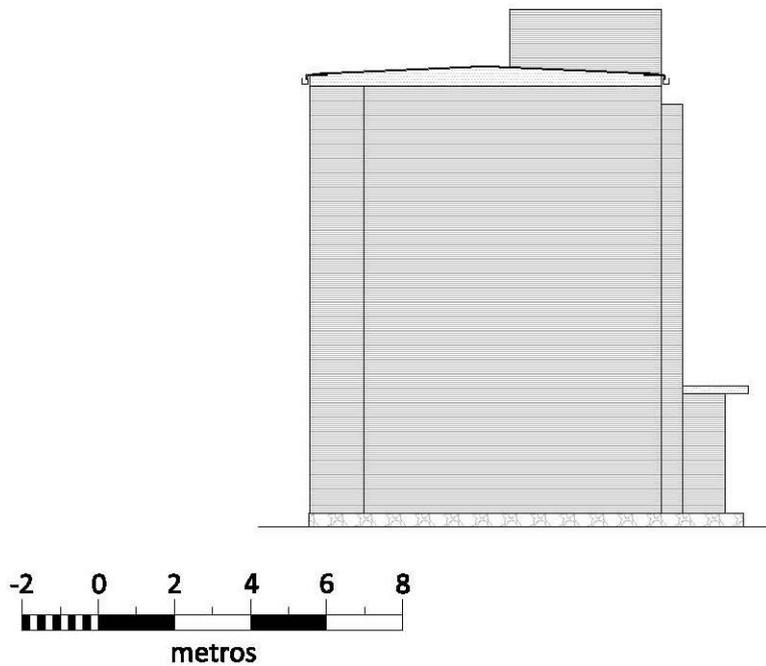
Plano de fachada este del bloque. Escala 1:200
